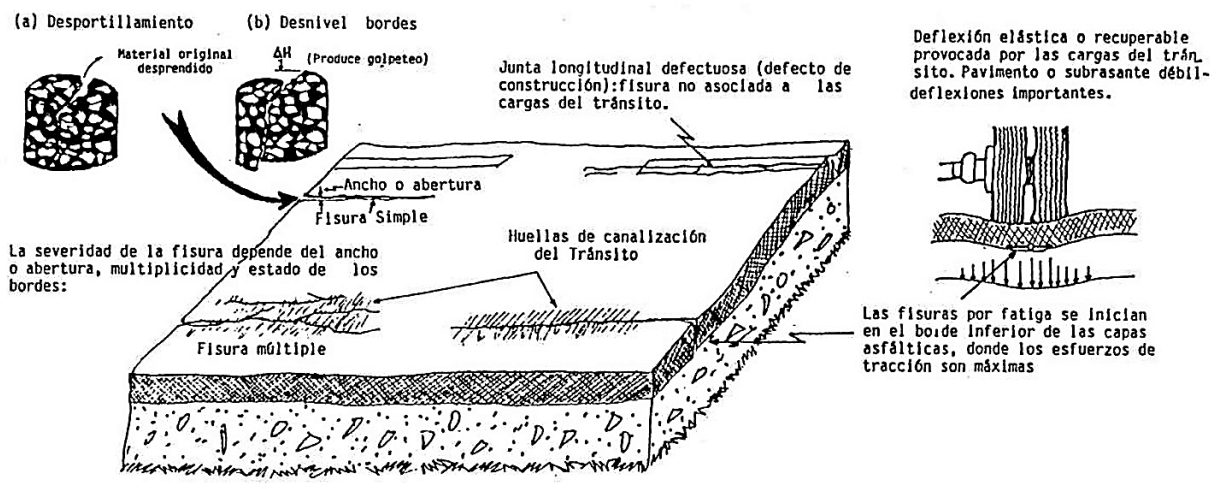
Esquema de fisuras longitudinales.⁵⁴
